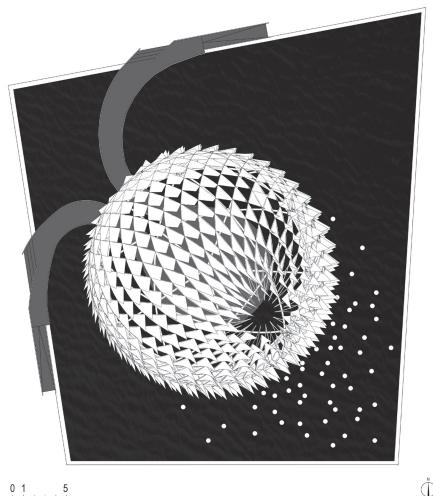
万灯喜月平面图 Fig.01 Golden Moon Plan 图02 万灯喜月剖面图 Fig.02 Golden Moon Section
